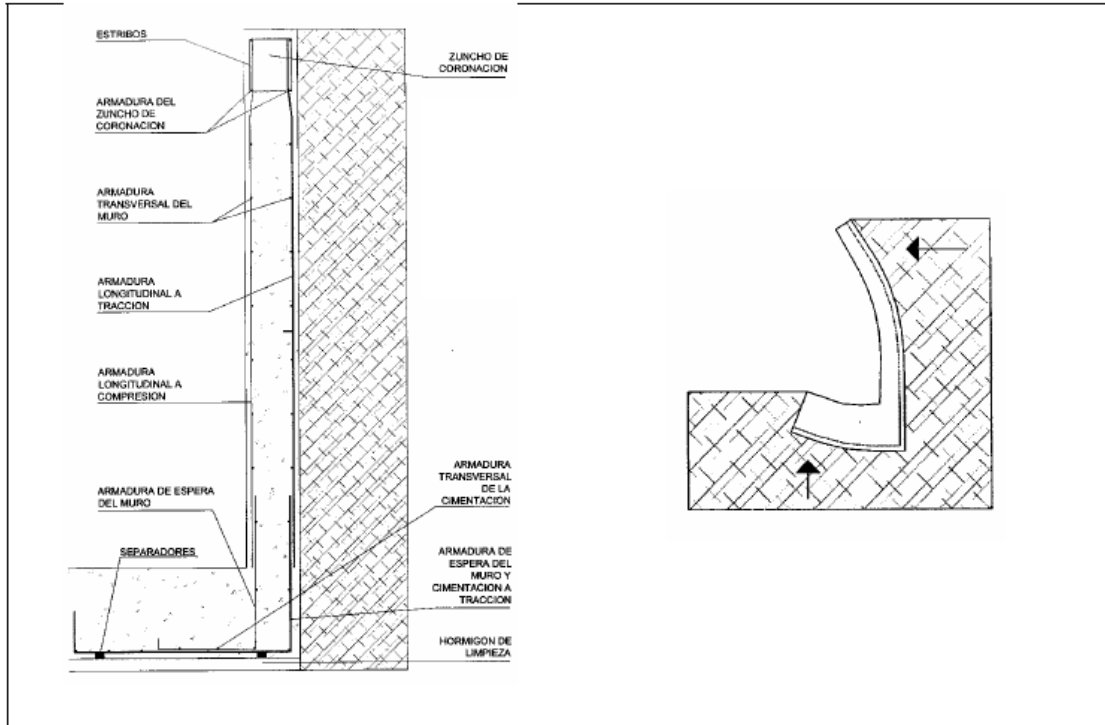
Armadura tipo y deformada en muros con puntera.
